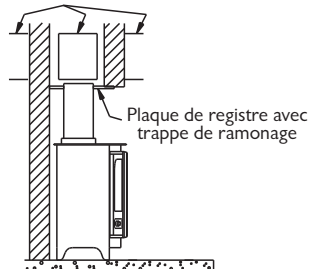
Plaque de registre horizontale avec conduit de fumée vers le haut
